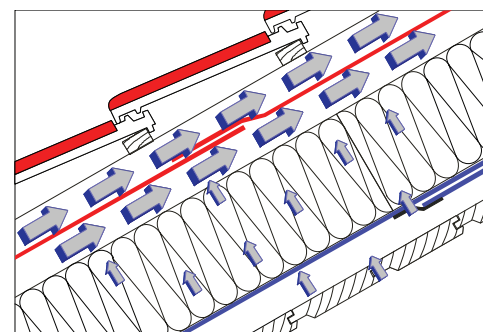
Конструкция крыши с двумя вентилируемыми зазорами
